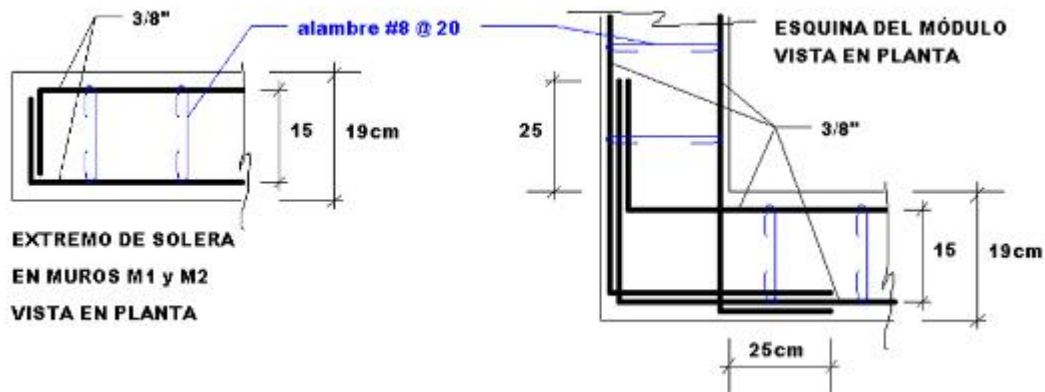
Detalles del refuerzo en extremos de la solera. Vista en planta.
